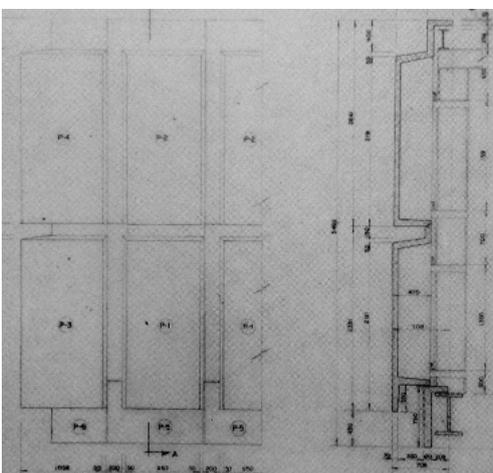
Alzado y sección constructiva paneles prefabricados de hormigón de la primera planta.
